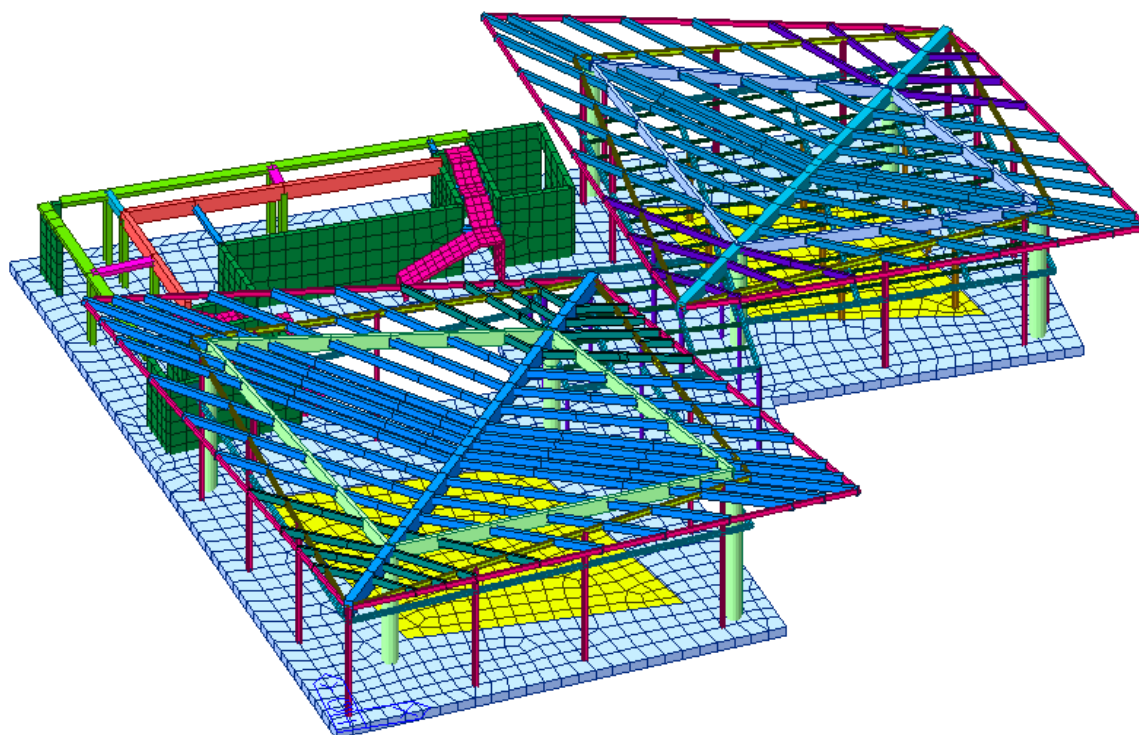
Schema strutturale del Centro Servizi, vista da Sud
